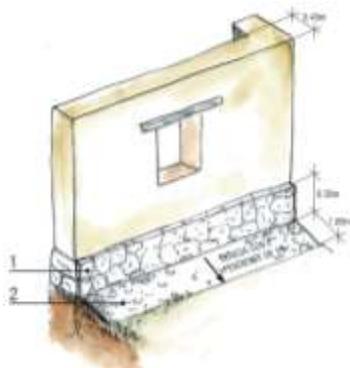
Zócalo de piedra como sobrecimiento. Fuente: MVCS, 2014.
